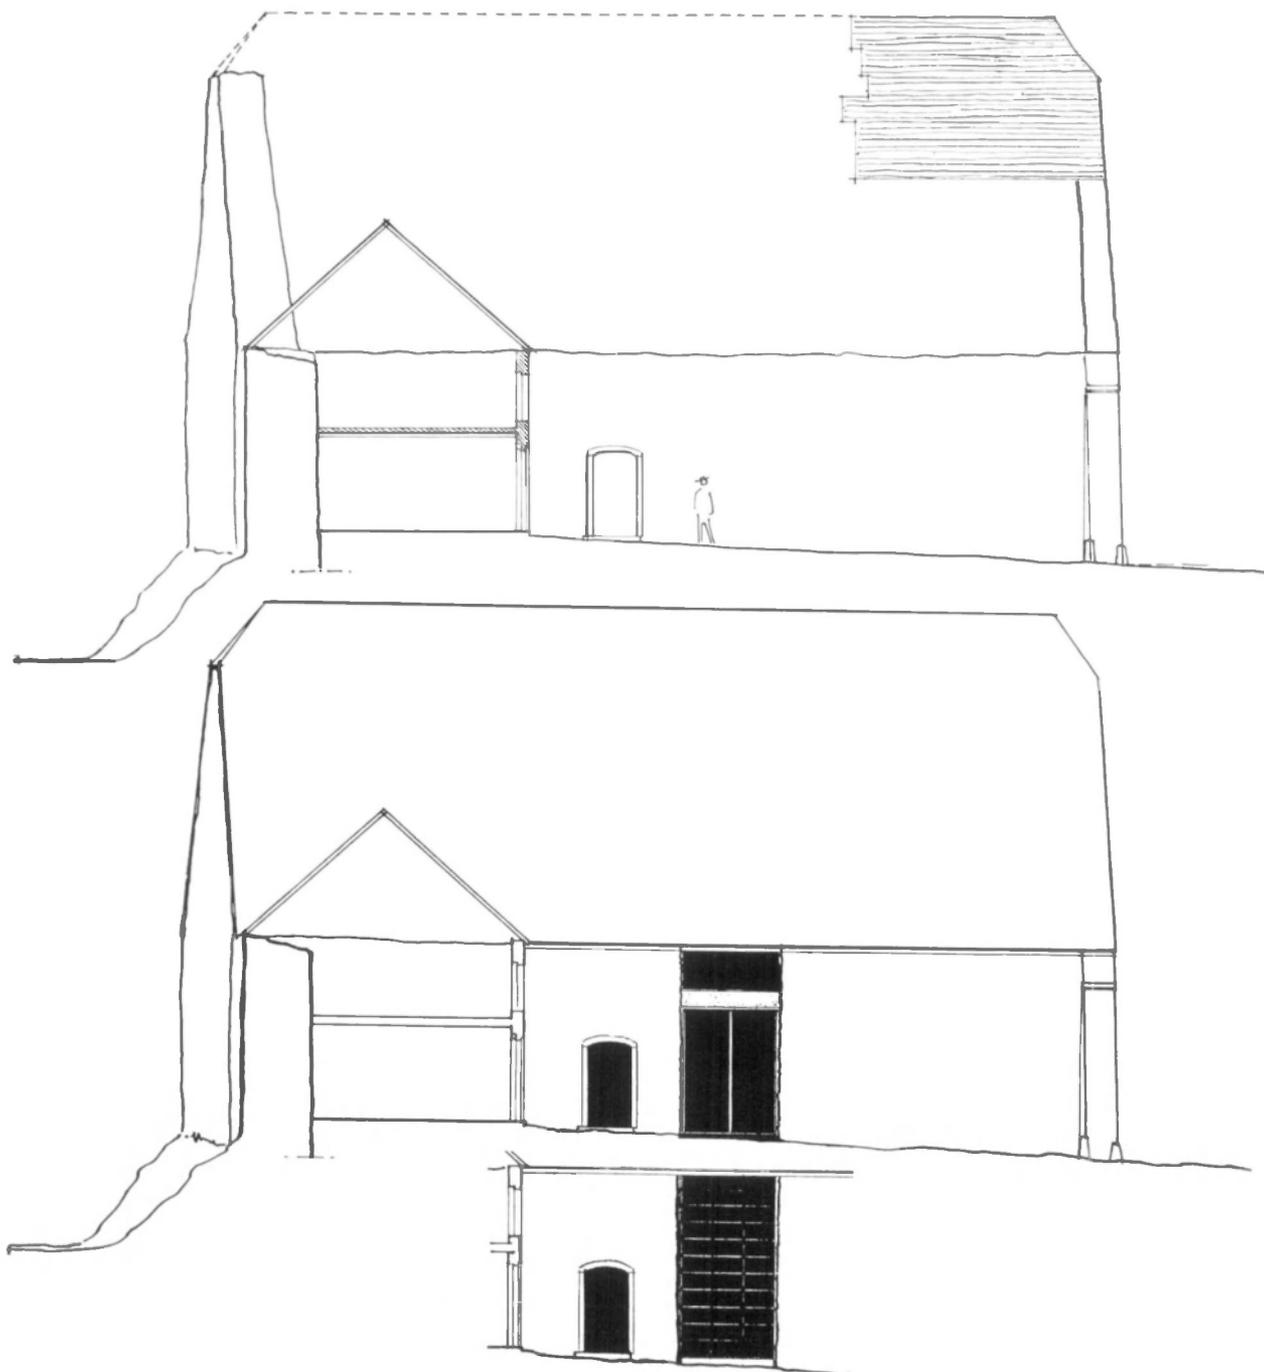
Opprebais. Esquisses pour la face nord. Echelle 1:200. En haut, état avant transformation. Au centre, état transformé avec porte à deux ouvrants vitrés, dont la traverse en béton correspond au passage du nouveau plafond et souligne un parti architectural d'horizontalité. En bas, variante de porte sectionnable escamotable par enroulement sous les combles.
